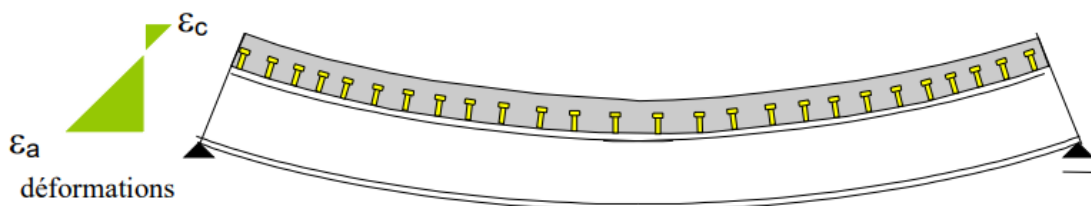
Fléchissement d'une poutre mixte sans glissement de la dalle par rapport à la poutrelle métallique
